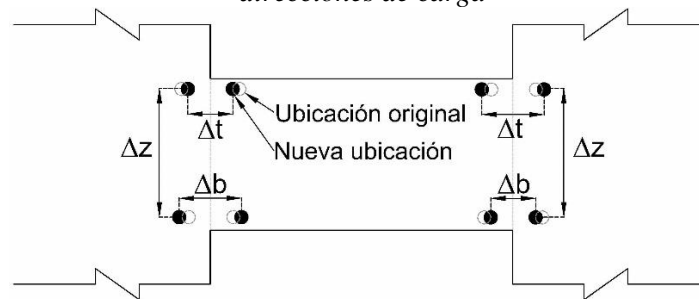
Notación para el cálculo de giros en la interfaz muro-viga de acoplamiento
